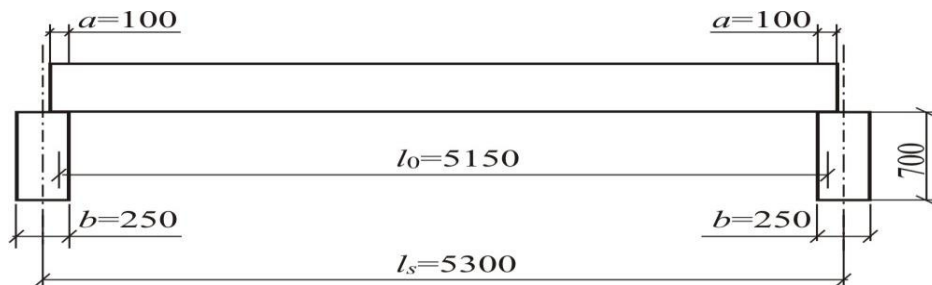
До визначення розрахункового прольоту поздовжнього ребра плити.
